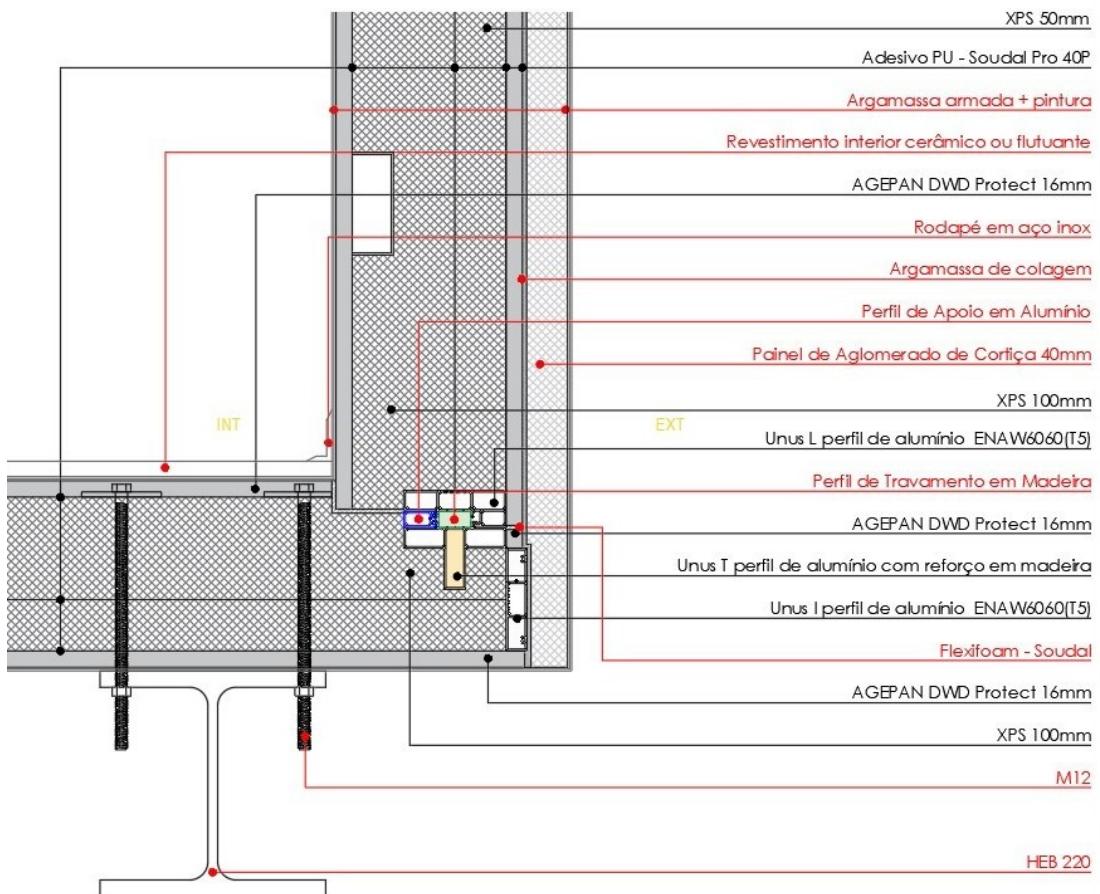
Pormenor construtivo de ligação de fundação em estrutura metálica, com piso e parede.
